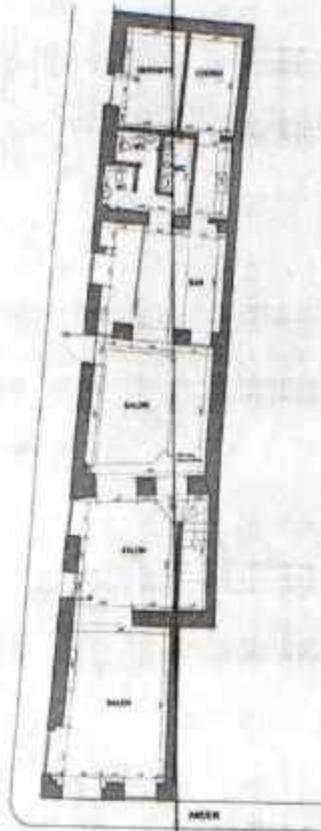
Plano RESTAURANTE TABACO Y RON BAR GOURMET COCKTAILS - Área privada.
